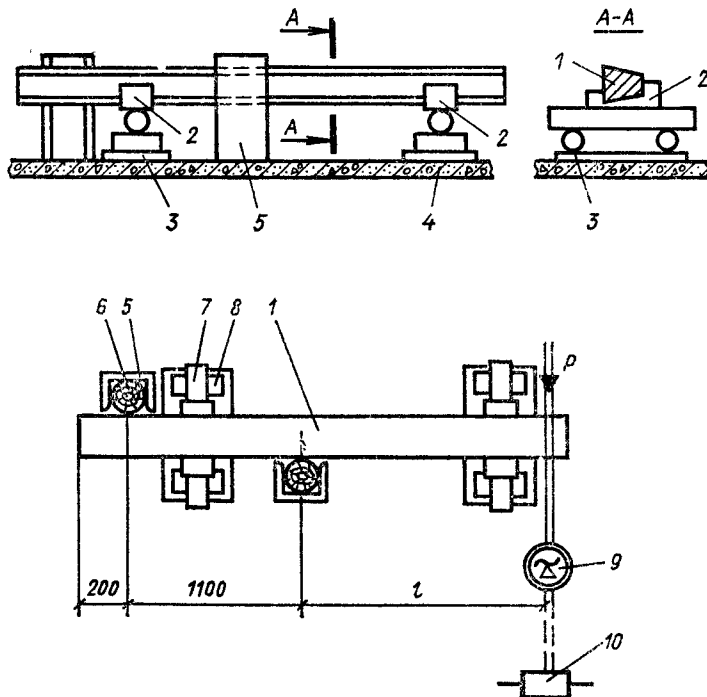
Схема испытания на трещиностойкость железобетонных свай под действием собственного веса
